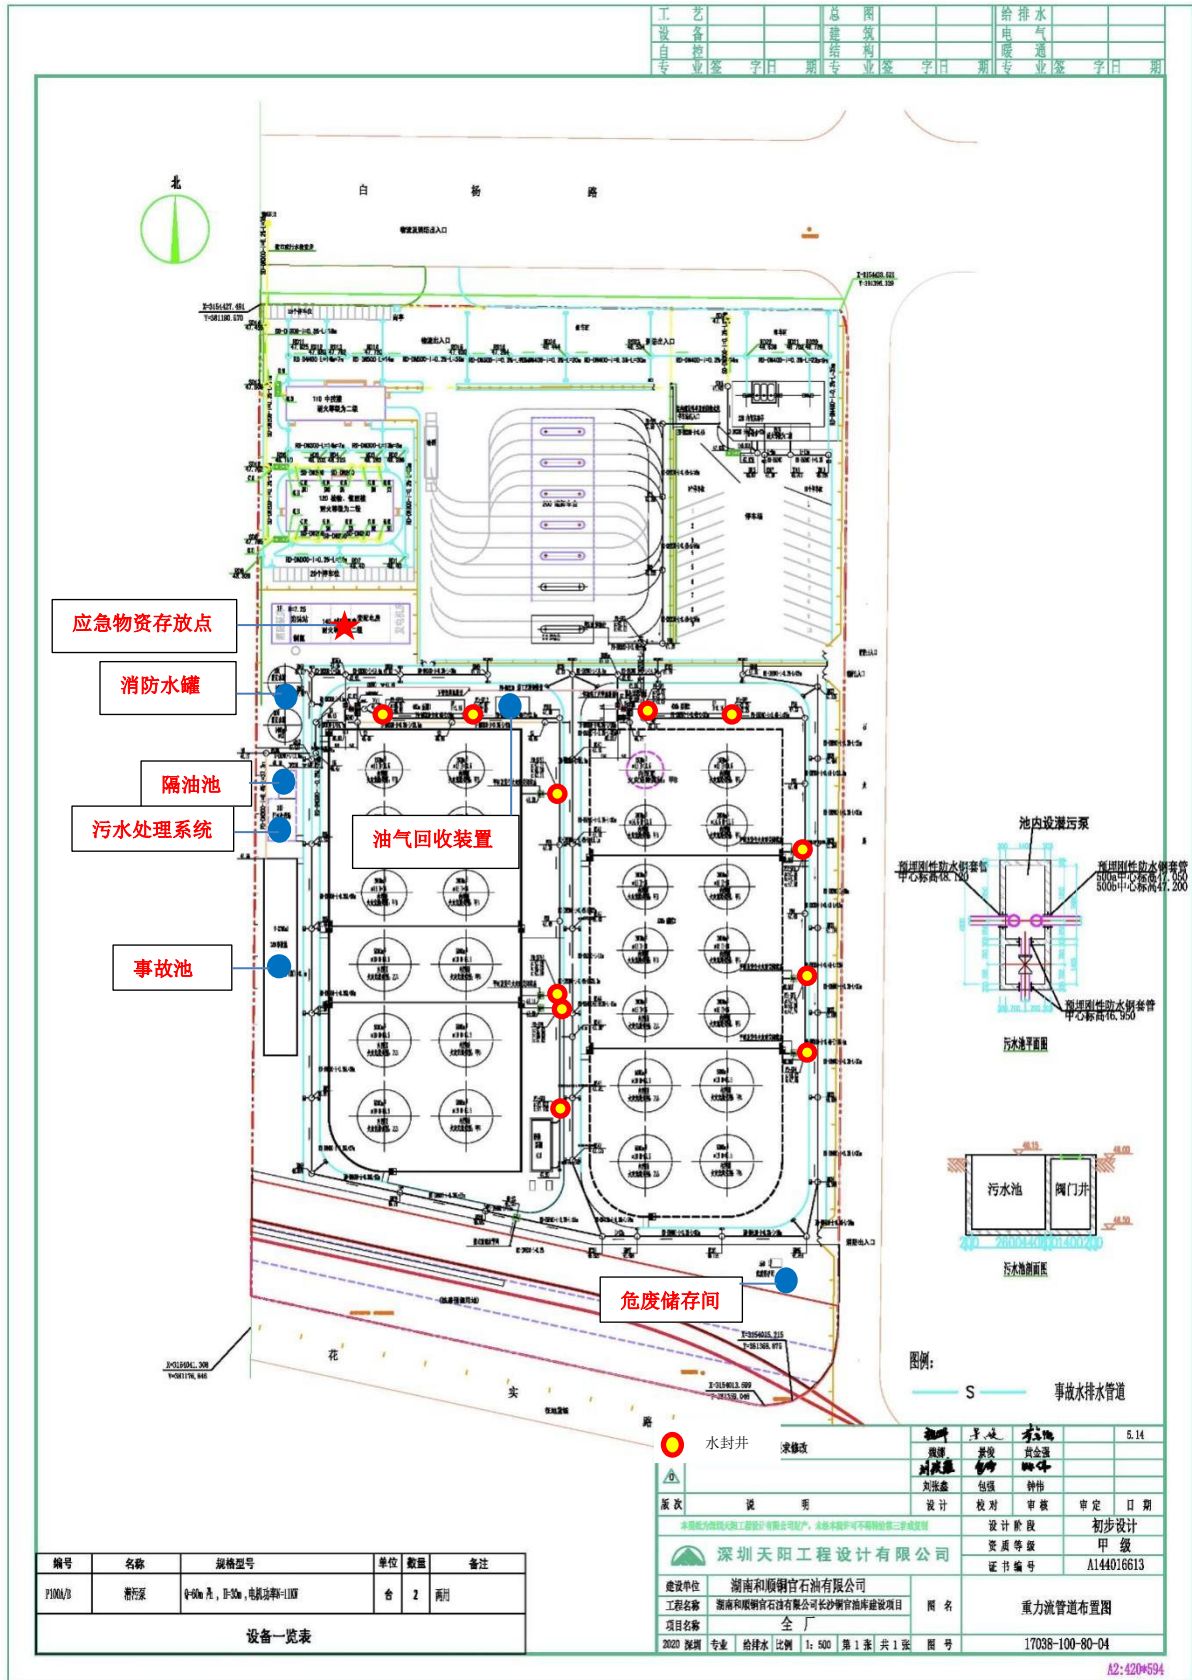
油库项目厂区总平面布置图及主要环保设施布置图
